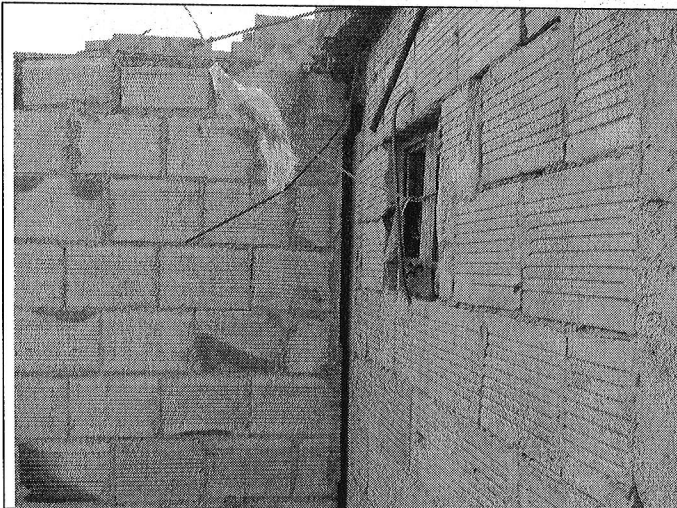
Desprendimiento del muro y la columna del costado norte, abertura de 10 cm aproximadamente, localizada en el lote 16 de la manzana 18 del sector (De acuerdo a la Figura 1).
